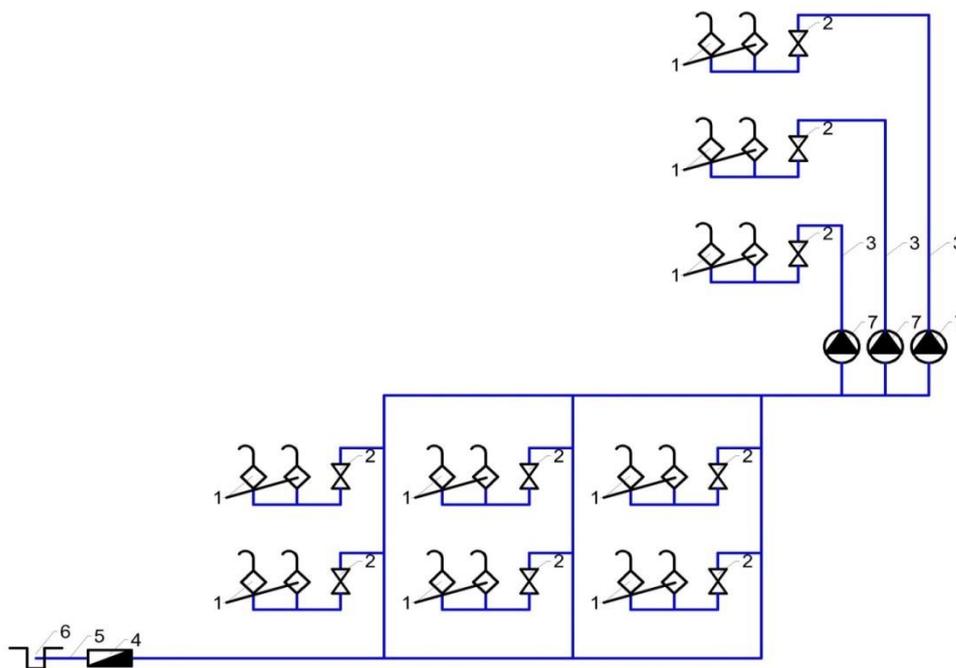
Внутренний водопровод. Зонная последовательная схема.
